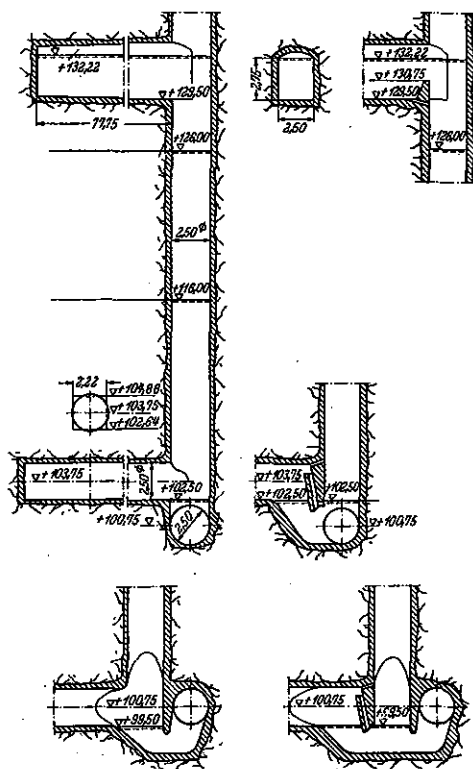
Exemplos de câmaras de equilíbrio inferiores rebaixadas
